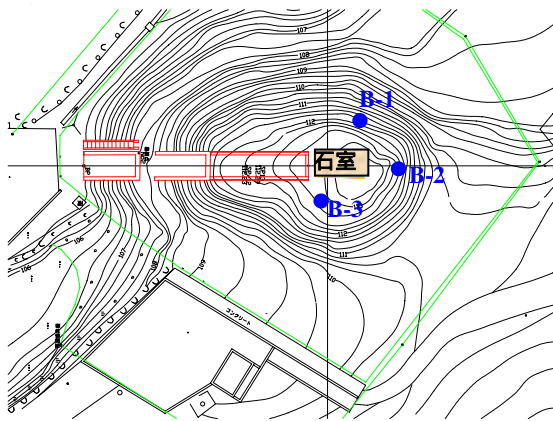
高松塚古墳の平面図と試料採取、含水比検層の位置
